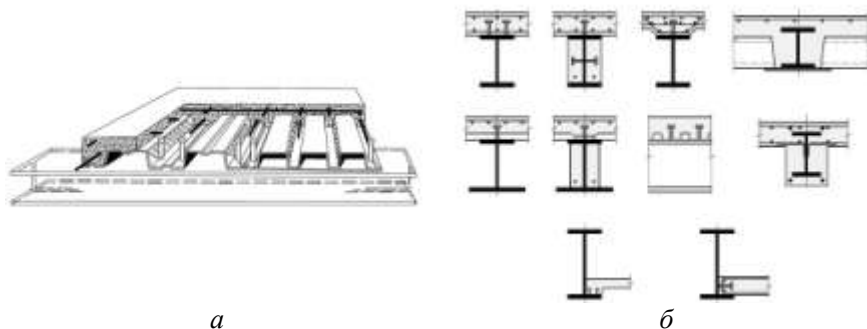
Изгибаемые сталежелезобетонные конструкции перекрытий:
